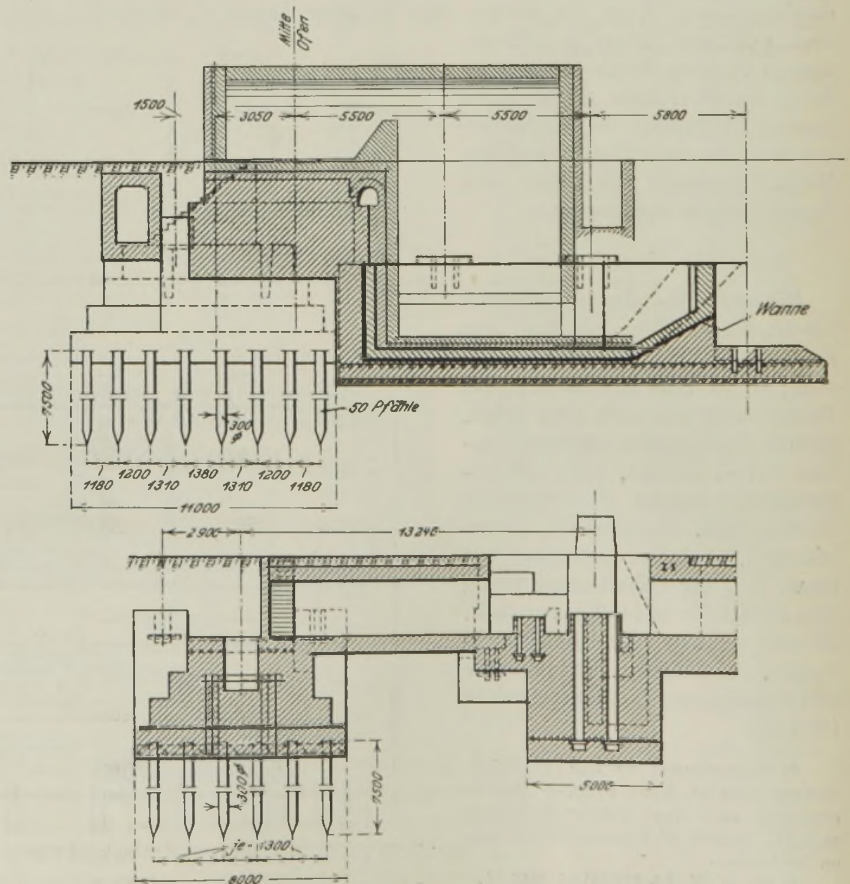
Beton-Pfahlgründung (200-t-Kippofen).
